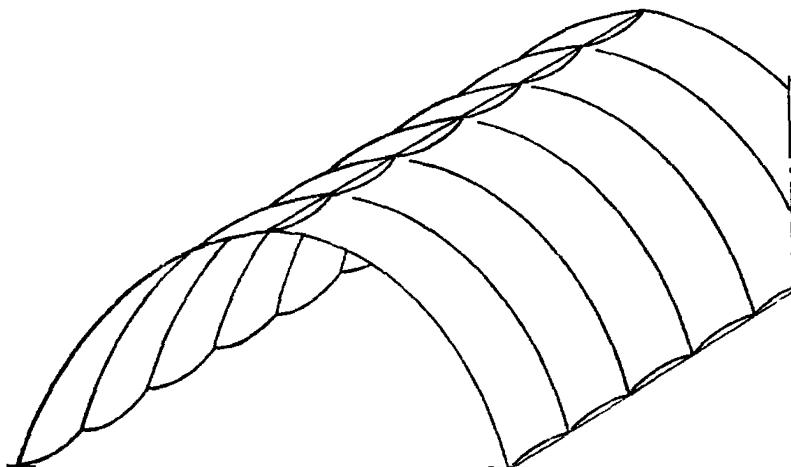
Сборные сводчатые покрытия пролетом 12—18 м с безрулонной кровлей из армоцементных элементов двойкой кривизны
